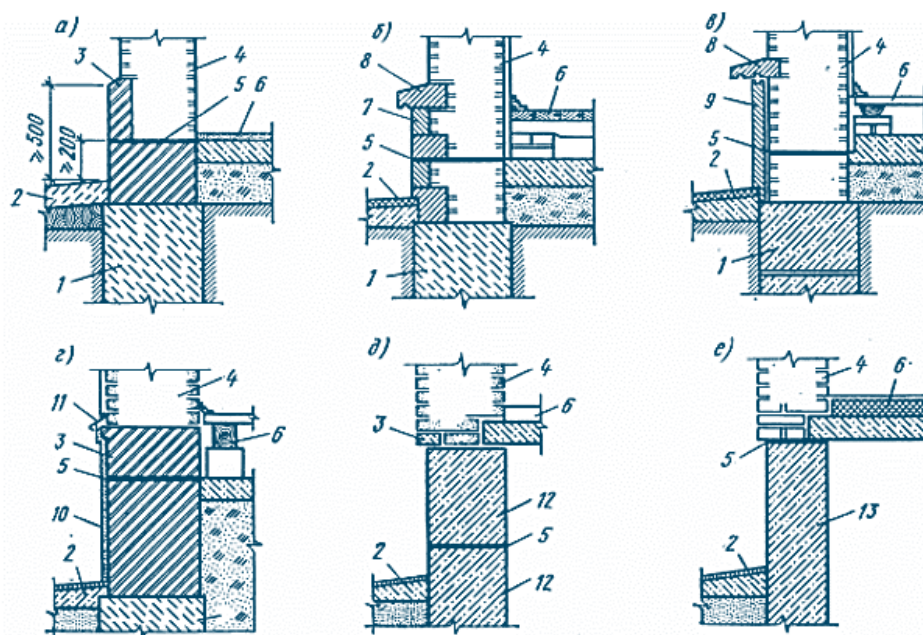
Типи конструкцій цоколя: а – облицьований цеглою; б – облицьований кам'яними блоками; в – те ж плитами; г – оштукатурений; д – з бетонних блоків; е – із залізобетонних панелей; 1 – фундамент; 2 – вимощення; 3 – обпалена цегла; 4 – стіна; 5 – гідроізоляція; 6 – конструкція підлоги першого поверху; 7 – цокольні кам'яні блоки; 8 – бортовий цокольний камінь; 9 – лицьовальні плити; 10 – штукатурка; 11 – покрівельна сталь; 12 – бетонний блок; 13 – панель фундаментної стіни
